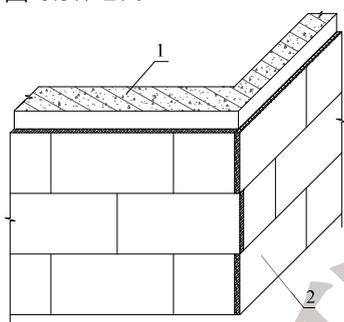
墙角保温板排板示意（尺寸单位：mm）
